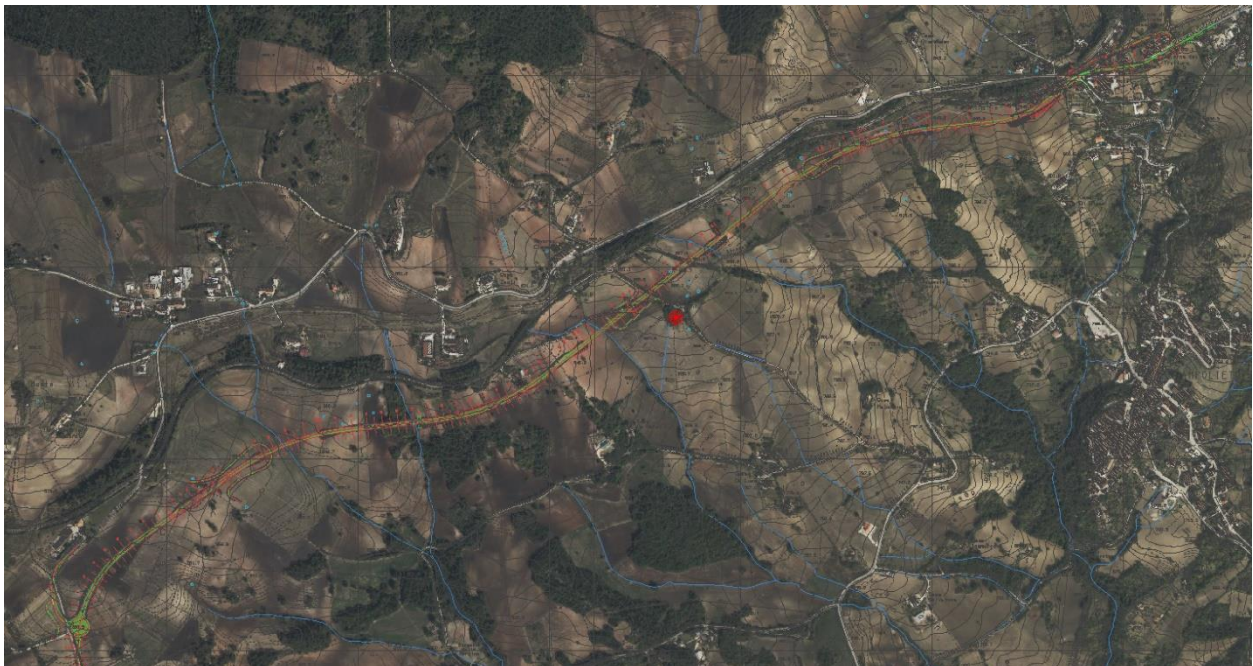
Planimetria generale dell'area di intervento con riportato il tracciato in progetto
